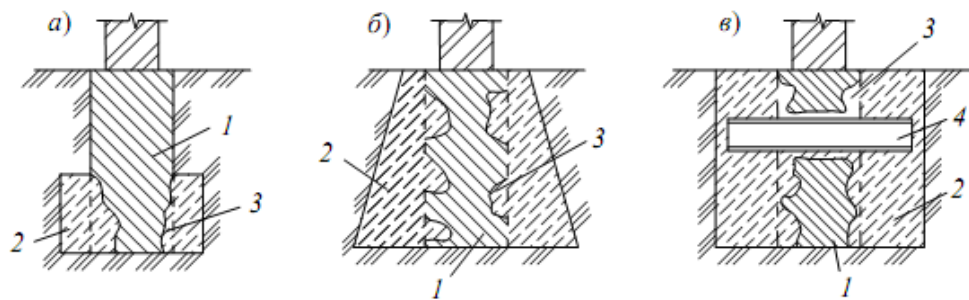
Схеми посилення стрічкових фундаментів бетонними обоймами:
